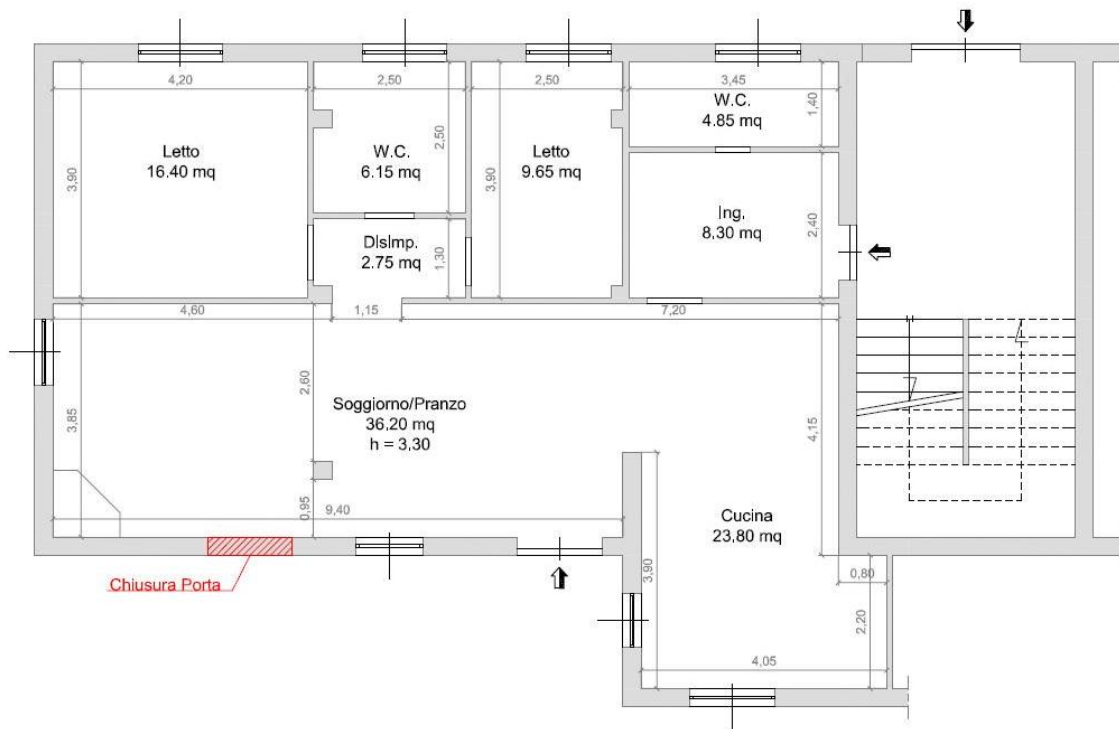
Planimetria Stato di fatto Foglio 46, p.lla 1235, sub 3.
